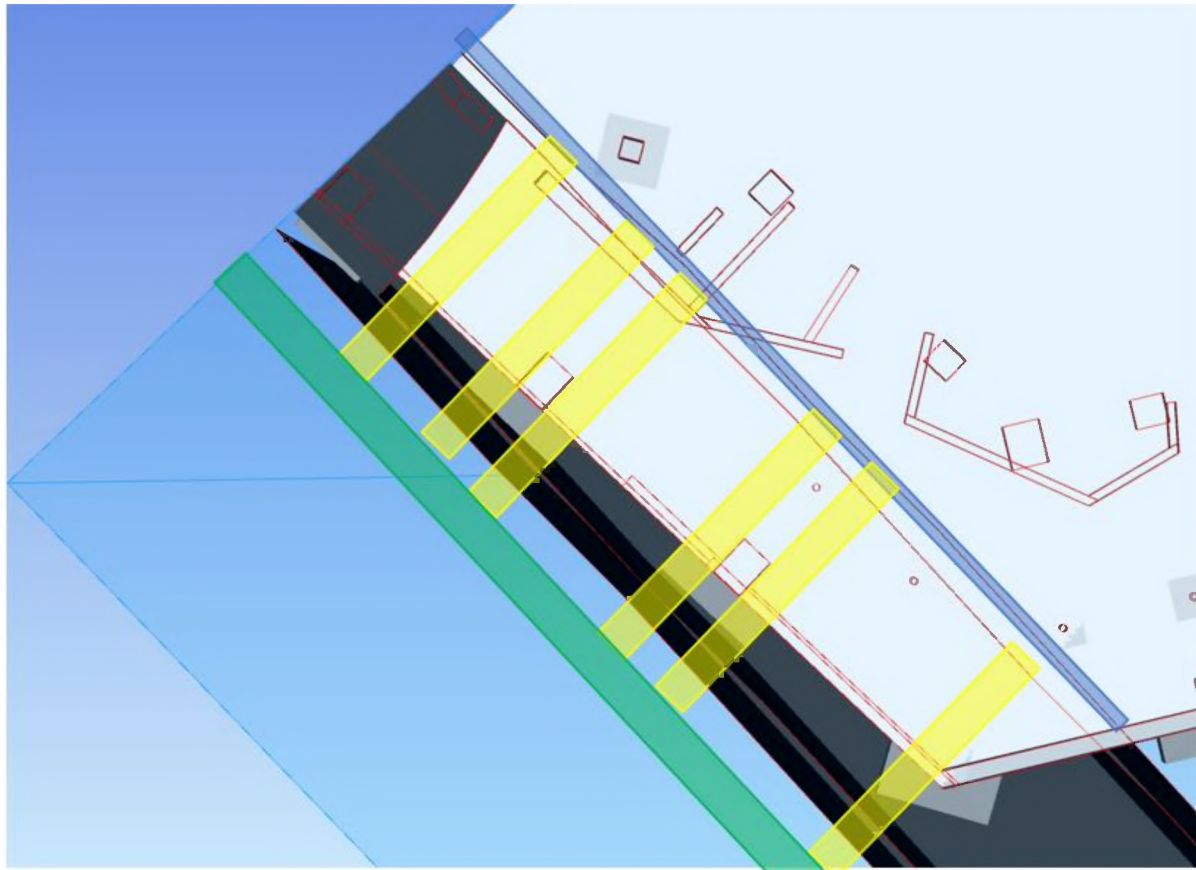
Horizontalschnitt auf der Höhe der zukünftigen Tunneldecke
